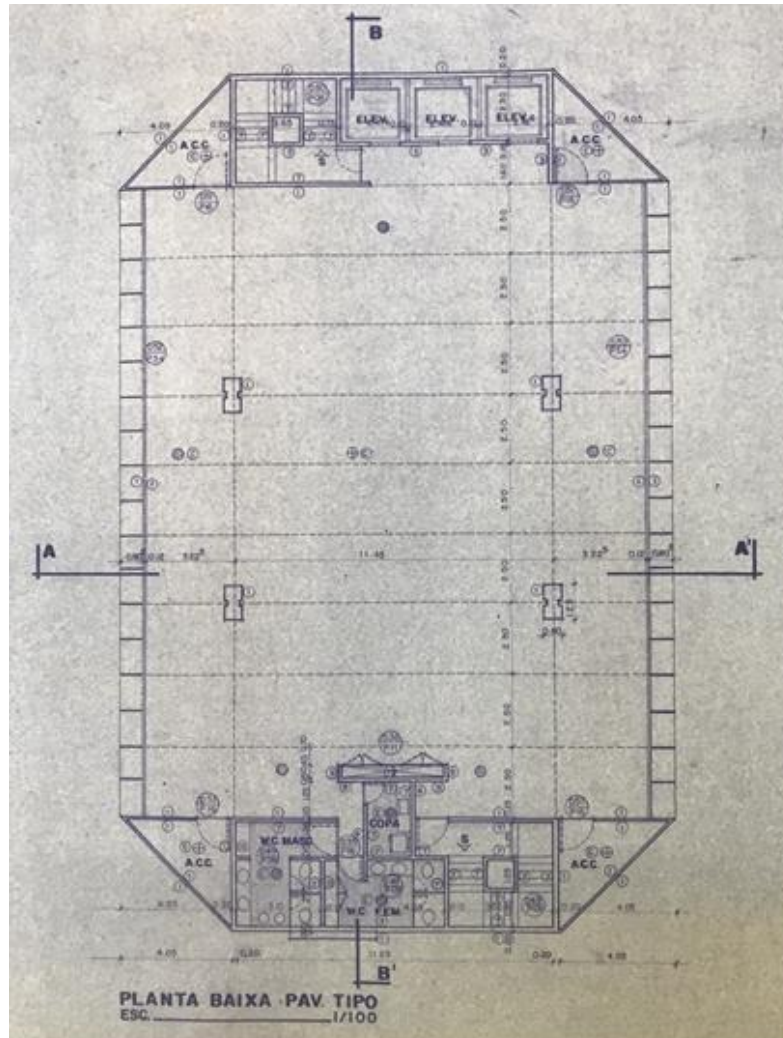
Planta Baixa - Pavimento Tipo. Fonte: Acervo Pontual Arquitetos.
